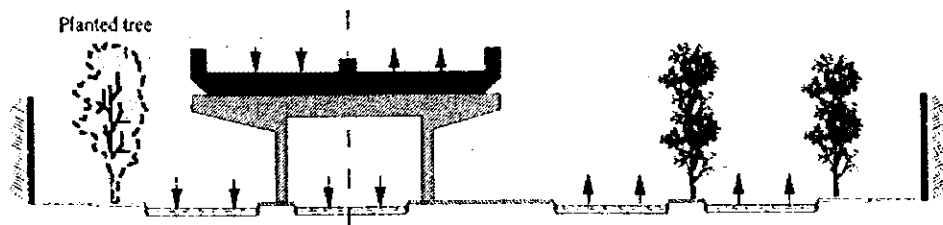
Ubicaci n de la Alternativa del plan de Alineamiento en la Calle 100.
